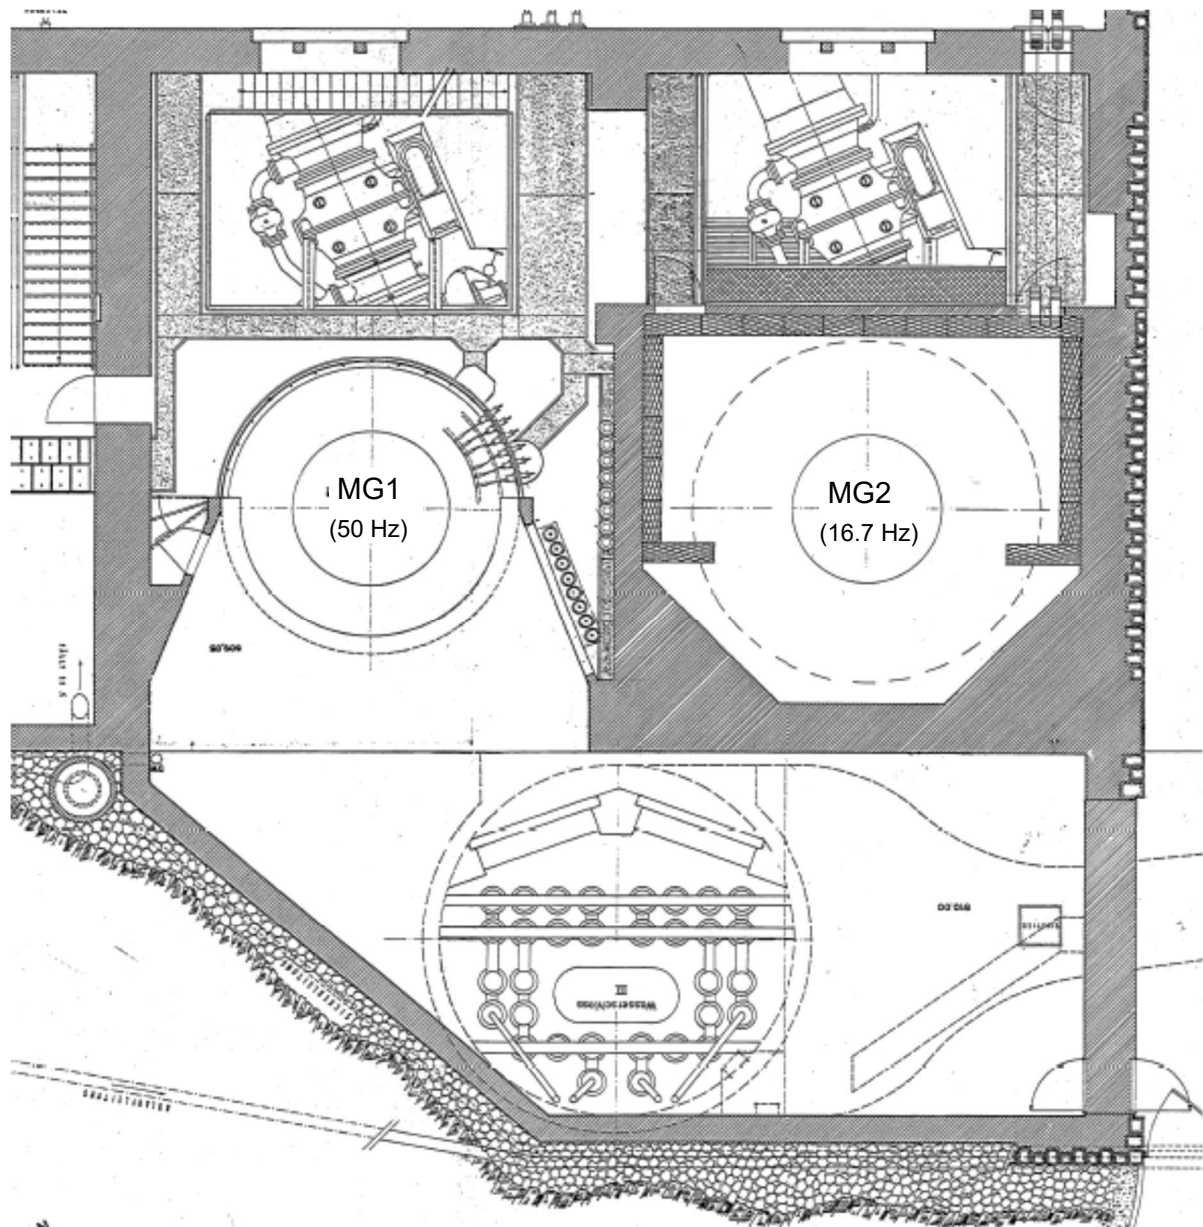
Grundriss Maschinensaal Kote 808.35
